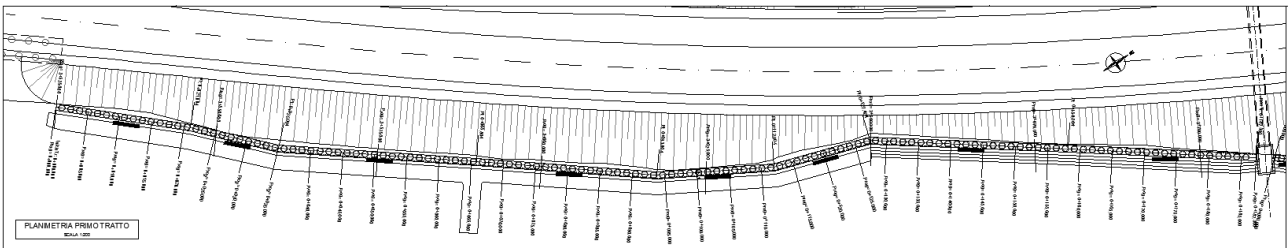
Opera di protezione del rilevato – planimetria primo tratto
